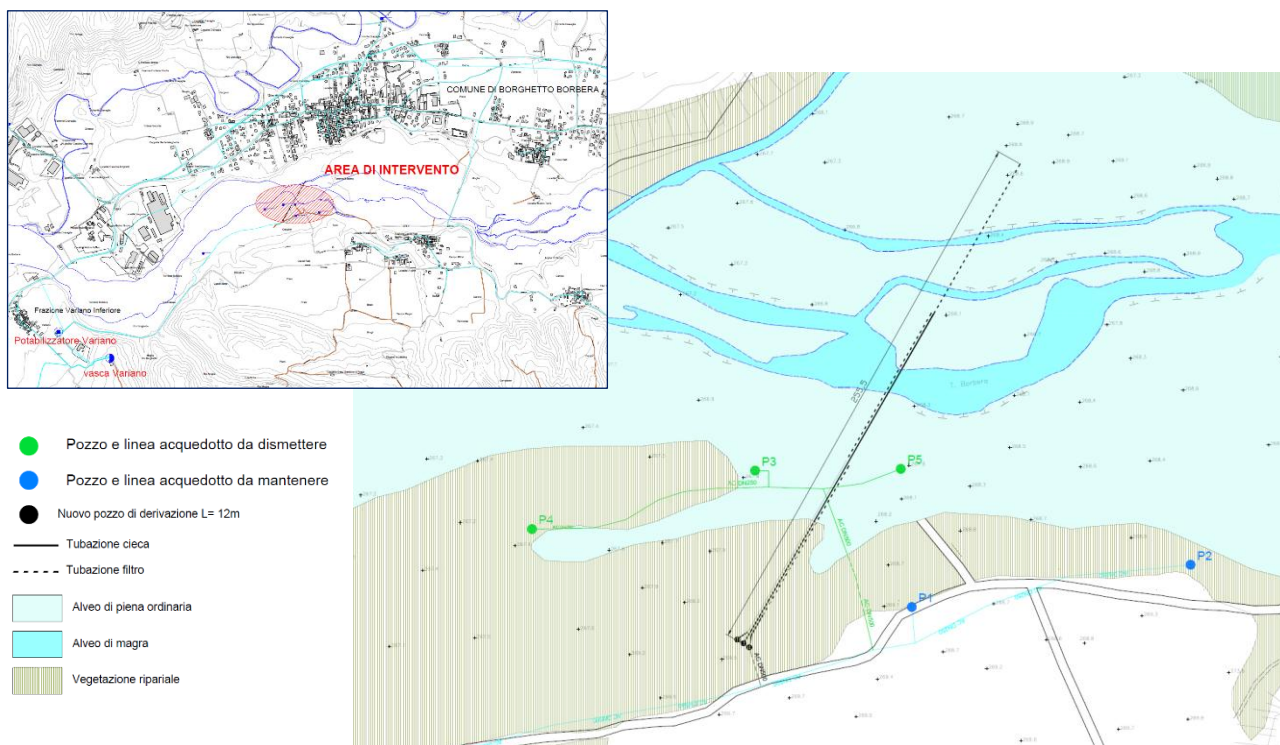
Inquadramento dell'intervento e dettaglio della nuova trincea drenante in progetto
